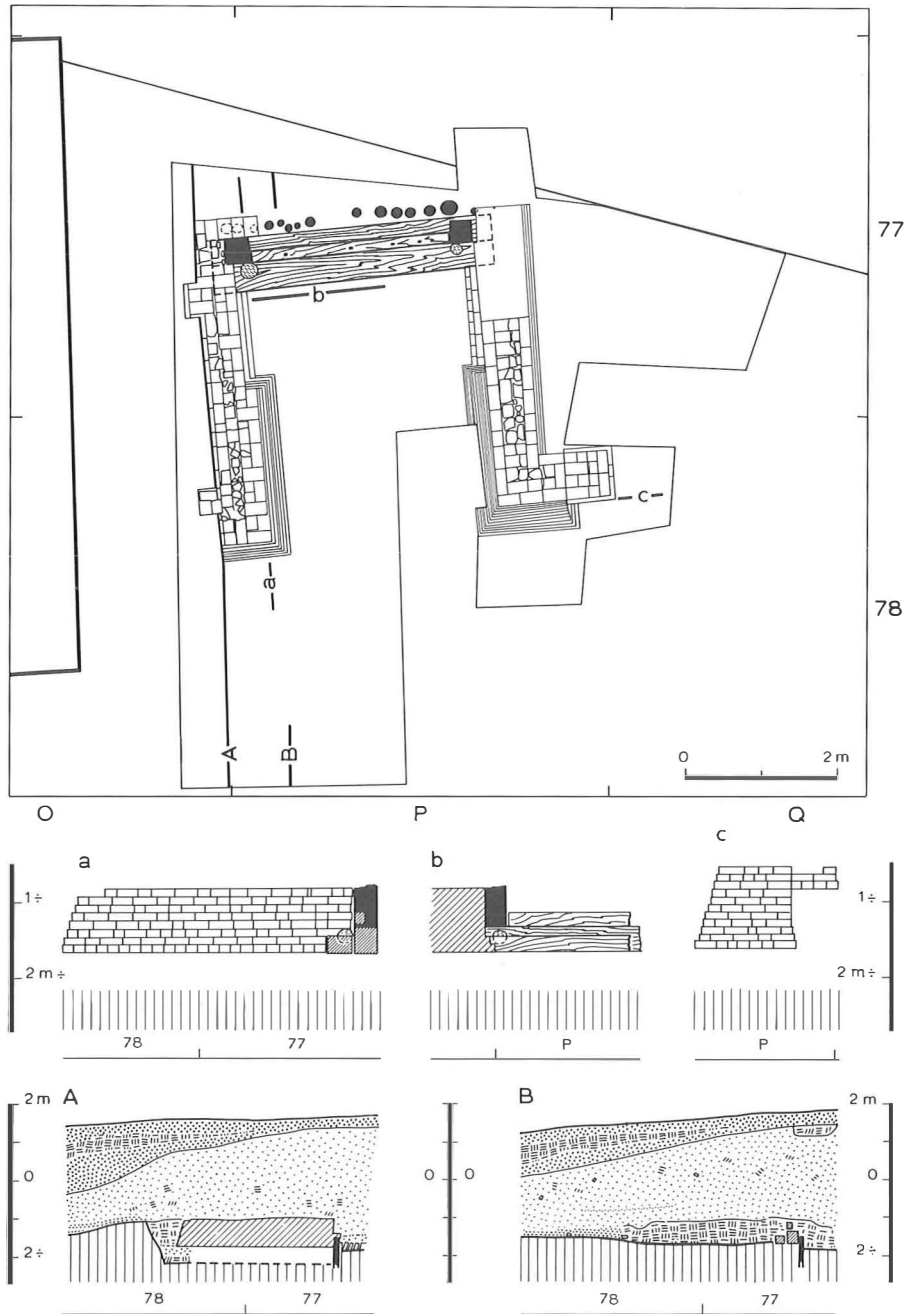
St. Bernardusabtei Aard. Schleuse. Grundriss, Ansichten und Profile. (S. Zeichenerklärung Abb. 64).
